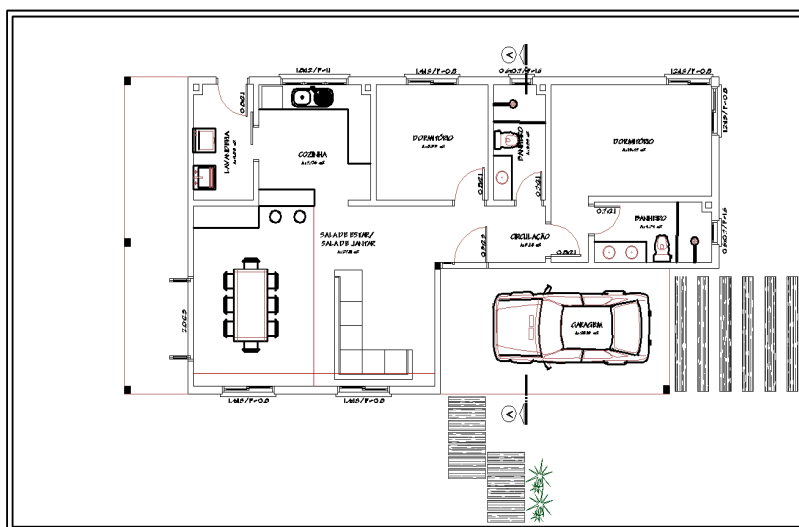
Planta baixa do projeto de instalações hidrossanitárias.
